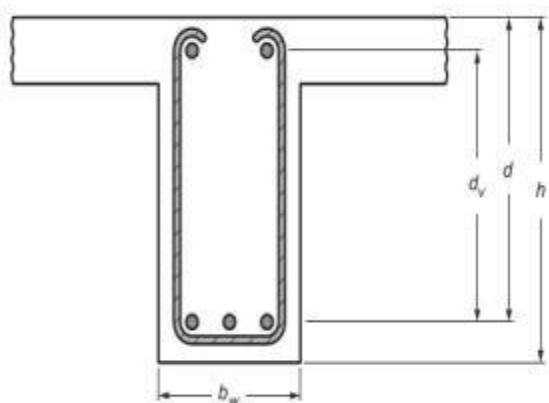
Largeur efficace de la nervure d'une poutre en T
